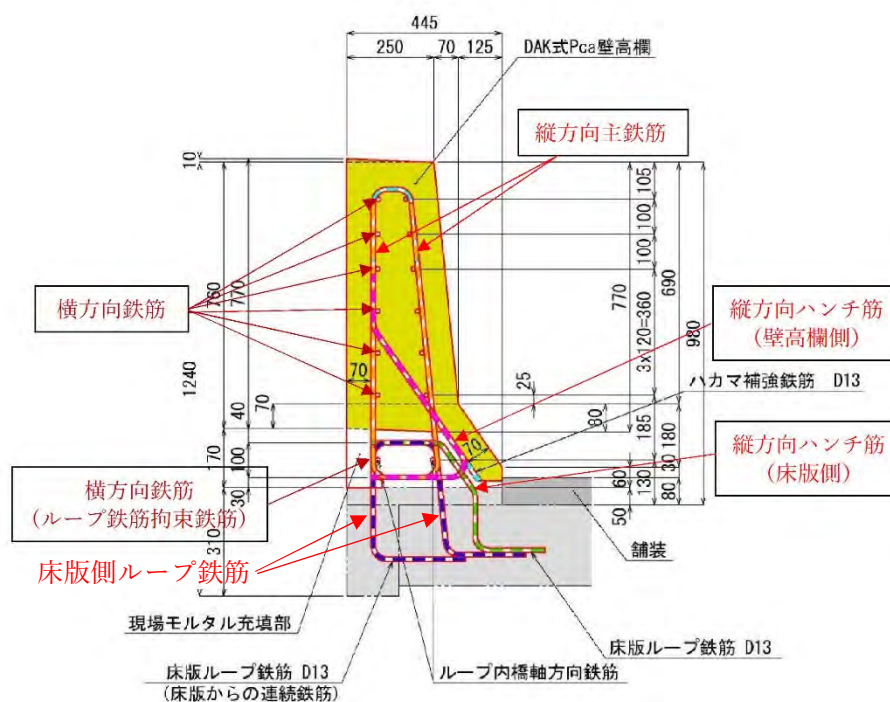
DAK 式壁高欄の標準鉄筋配置図
